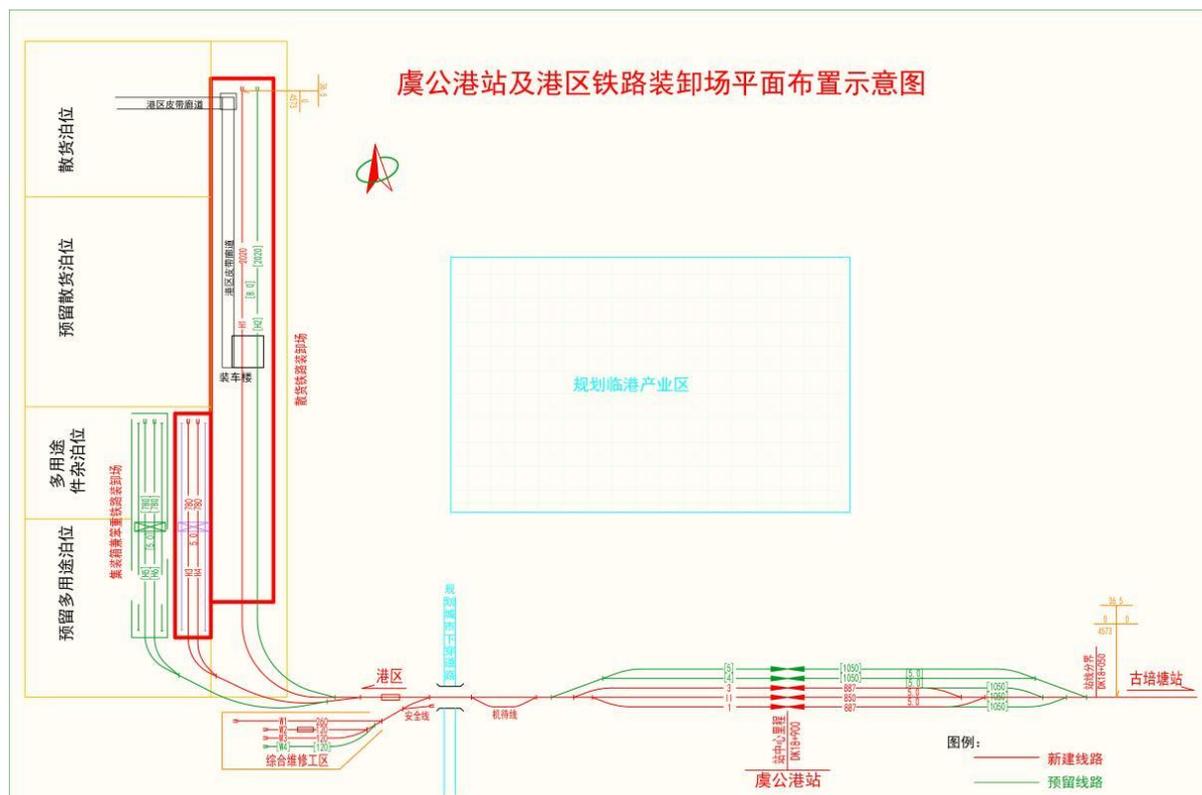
虞公港站及港区铁路装卸场平面布置示意图
